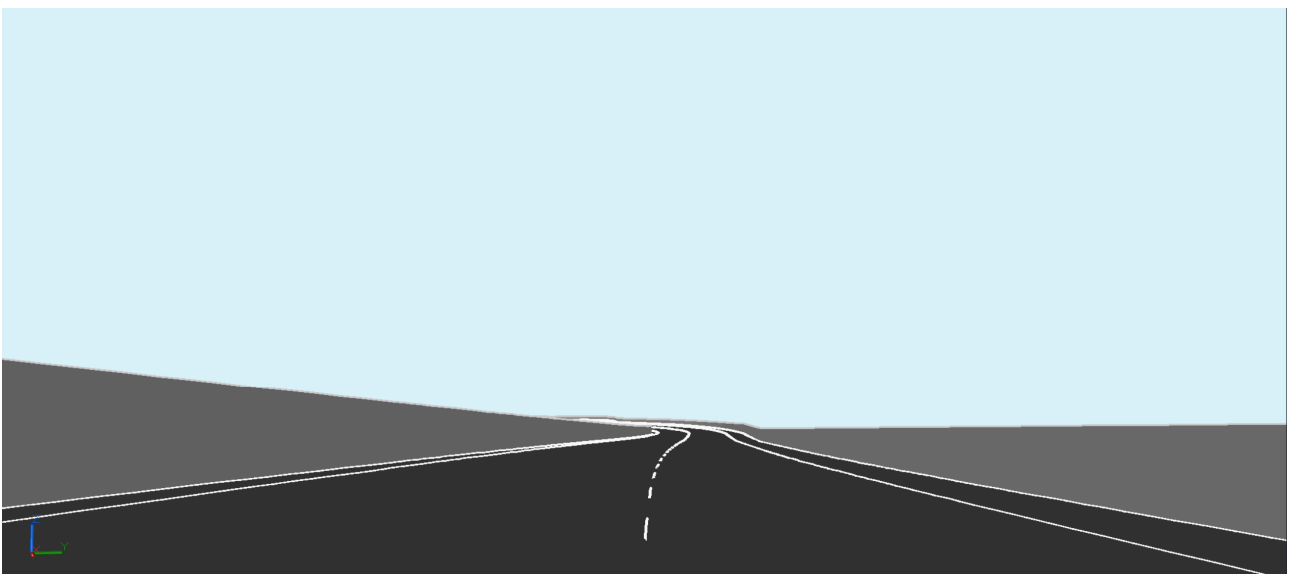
Visione prospettica in uscita alla curva planimetrica 12 (Carr. FA-GR)
